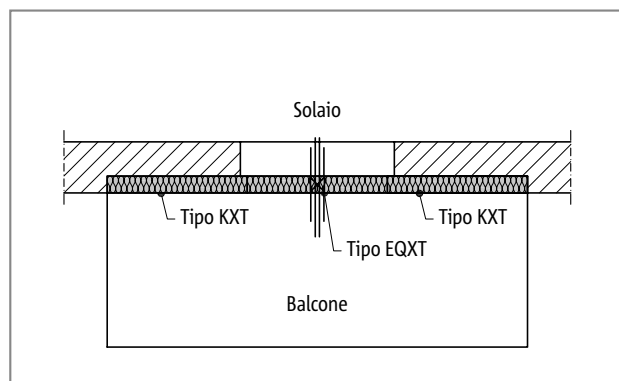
Schöck Isokorb® tipo EQXT: balcone a sbalzo con momento positivo
